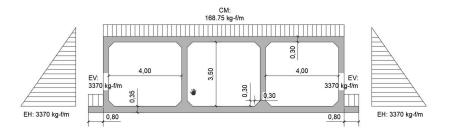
Análisis de cargas de la estructura marco de concreto armado. Fuente: Elaboración propia
